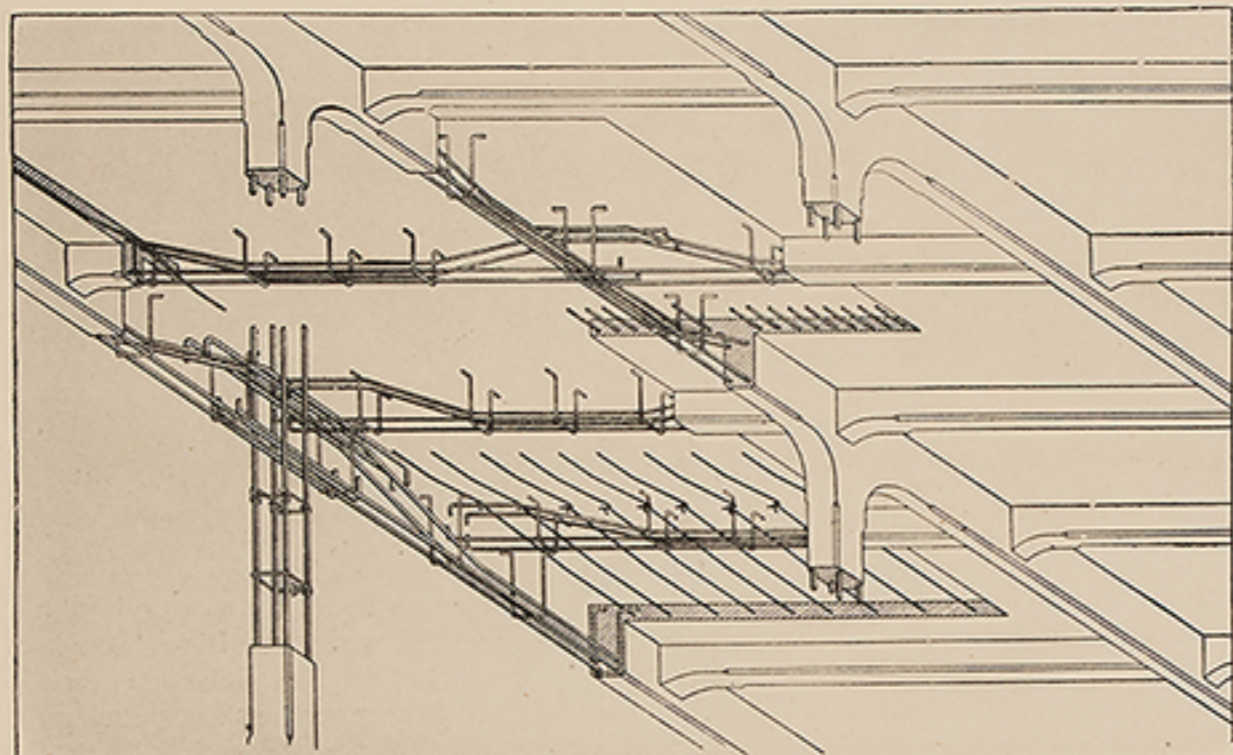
Uebersichtsplan für die Bewehrung der Eisenbetonsäulen und für ihre Verbindung mit den Deckenteilen.
